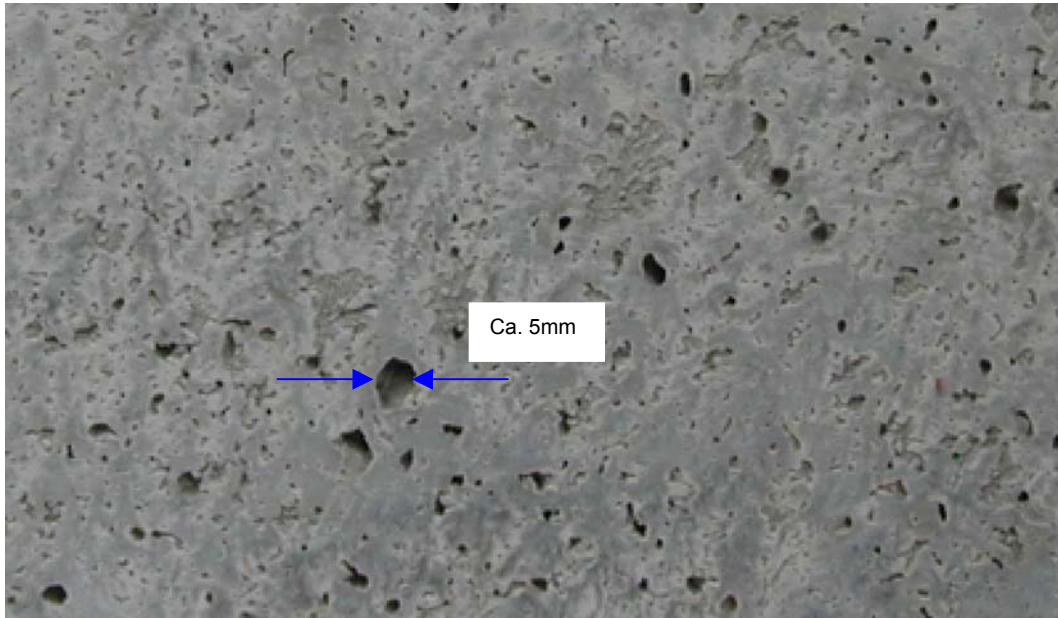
porige Oberfläche, Betonqualität nicht beeinträchtigt, Schadenklasse 4
